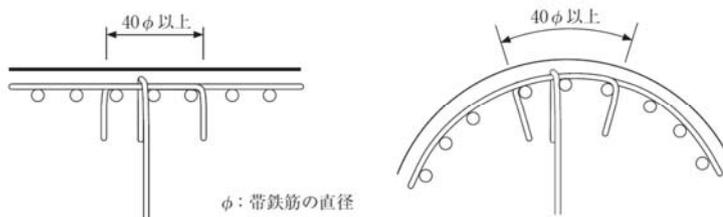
直角フックを有する帯鉄筋の定着例 (道示V編, 図-解6.2.6)
